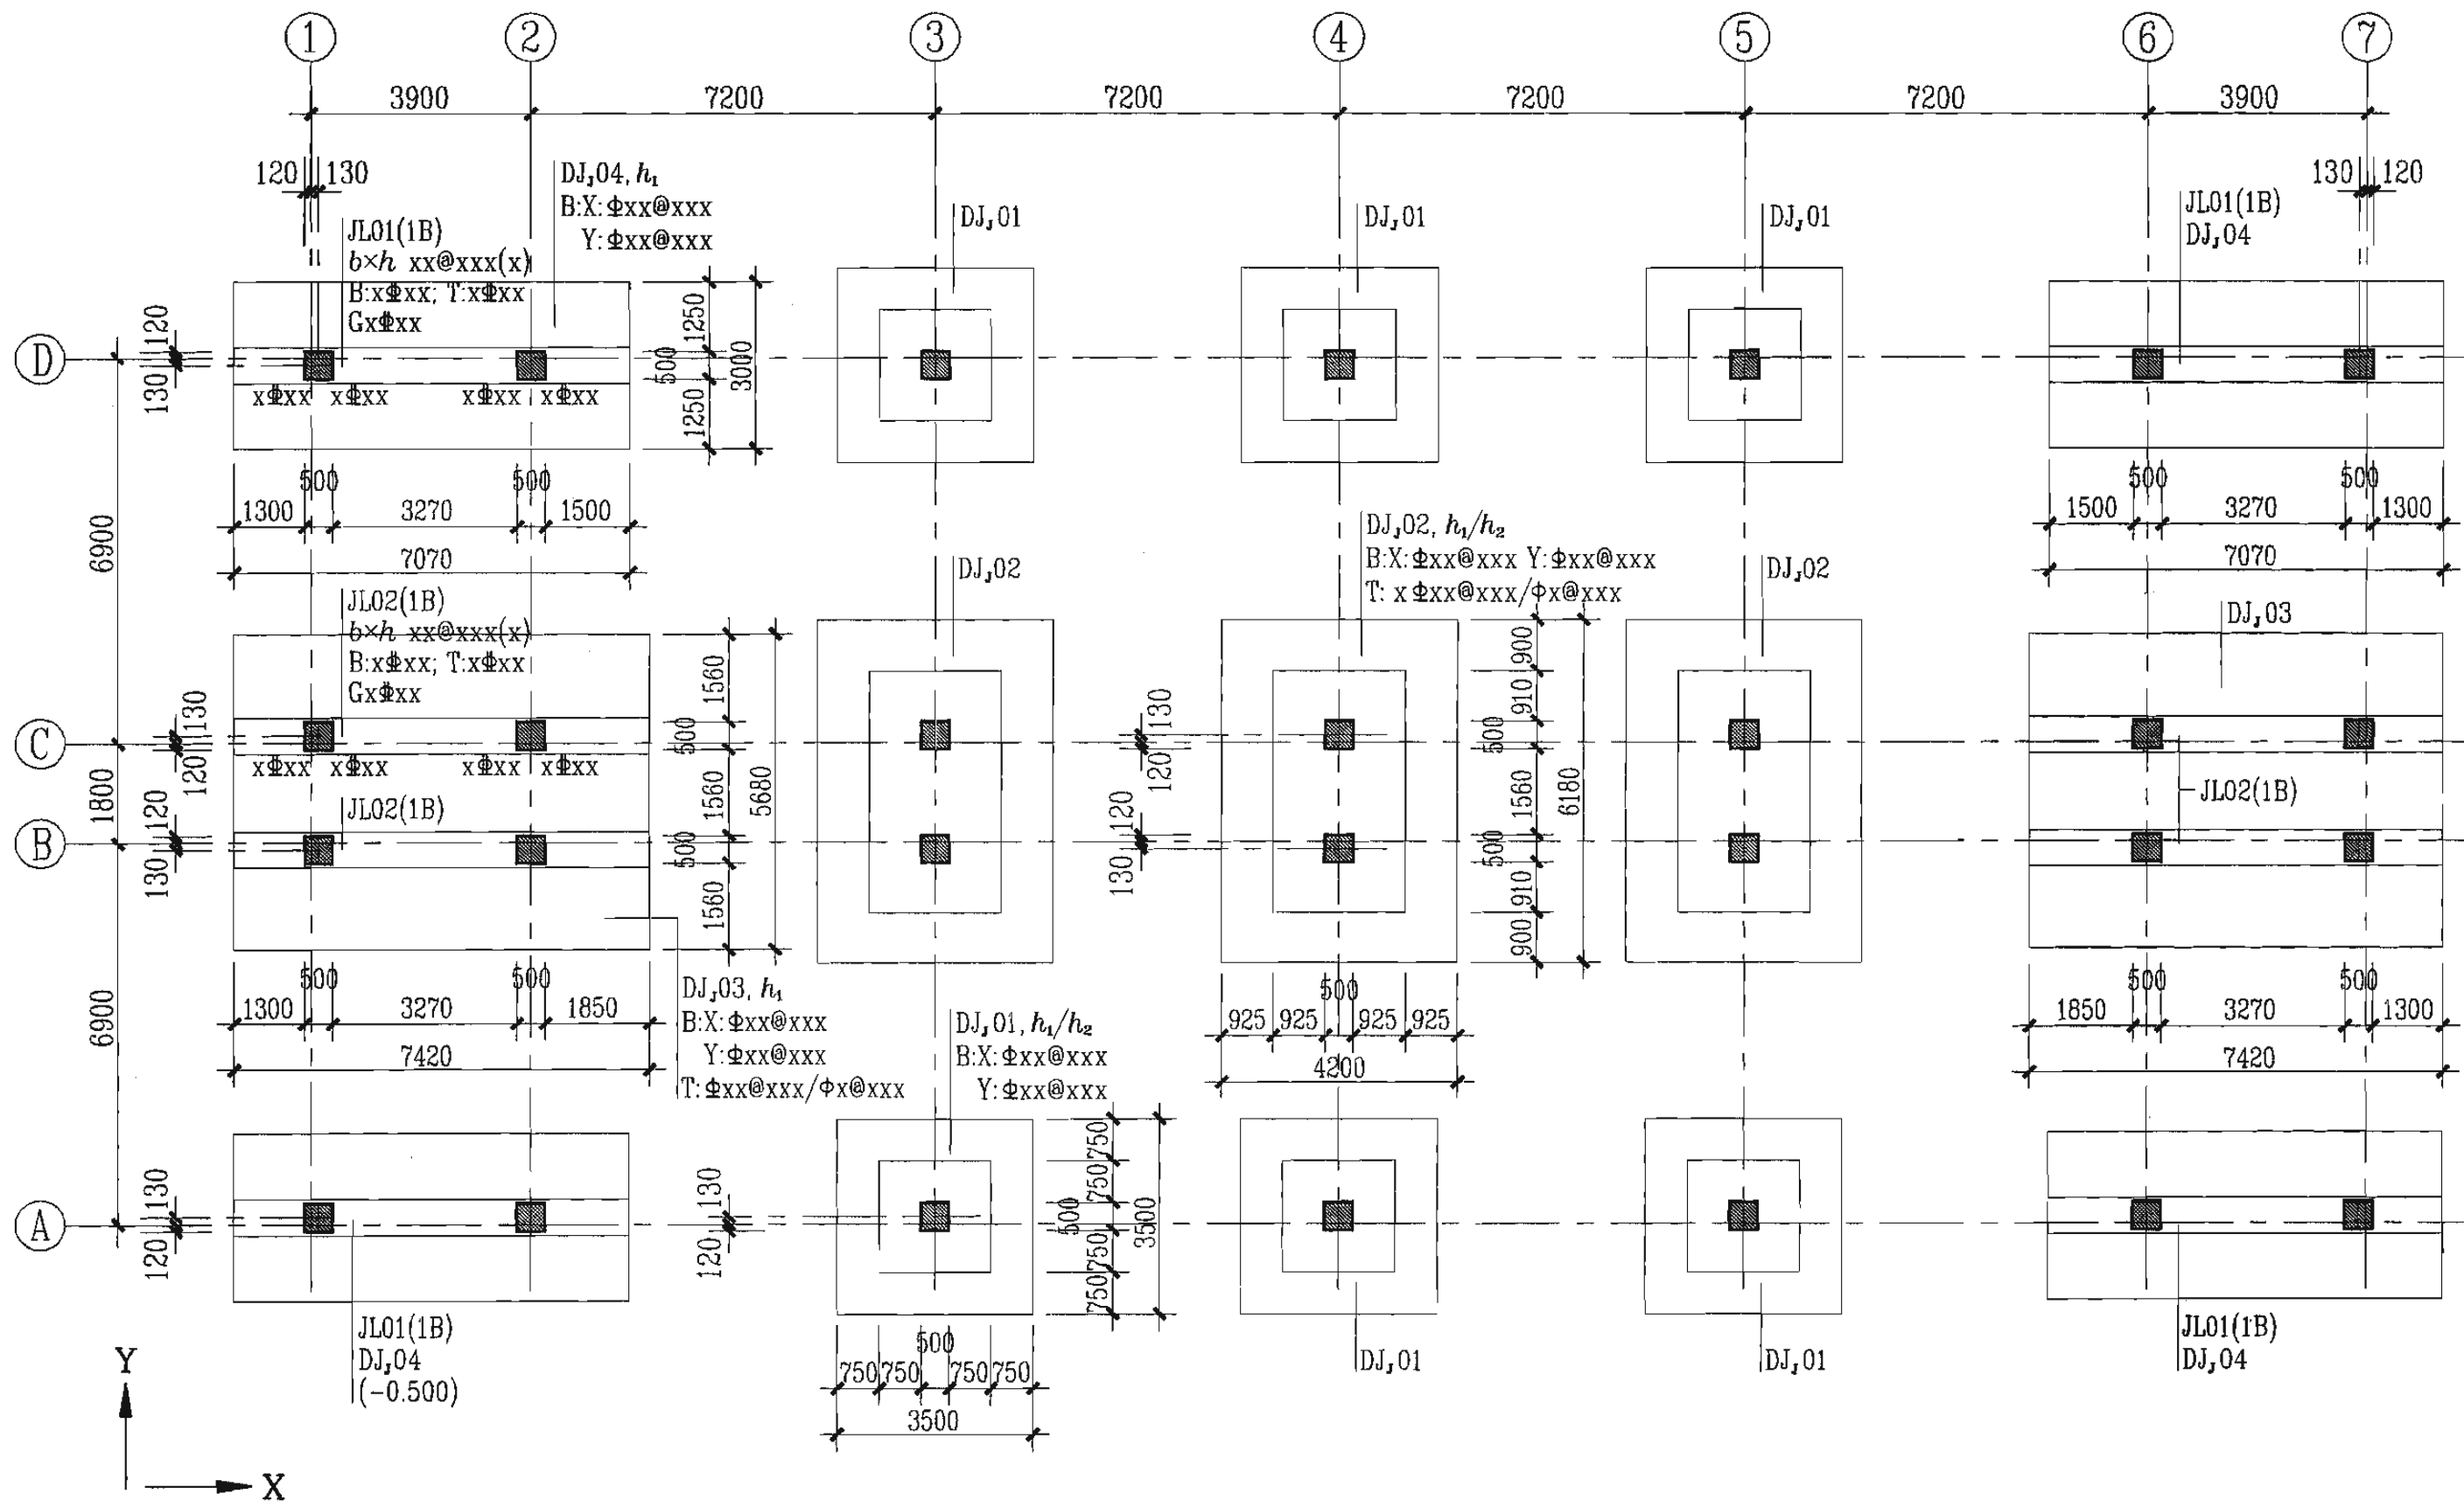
采用平面注写方式表达的独立基础设计施工图示意
